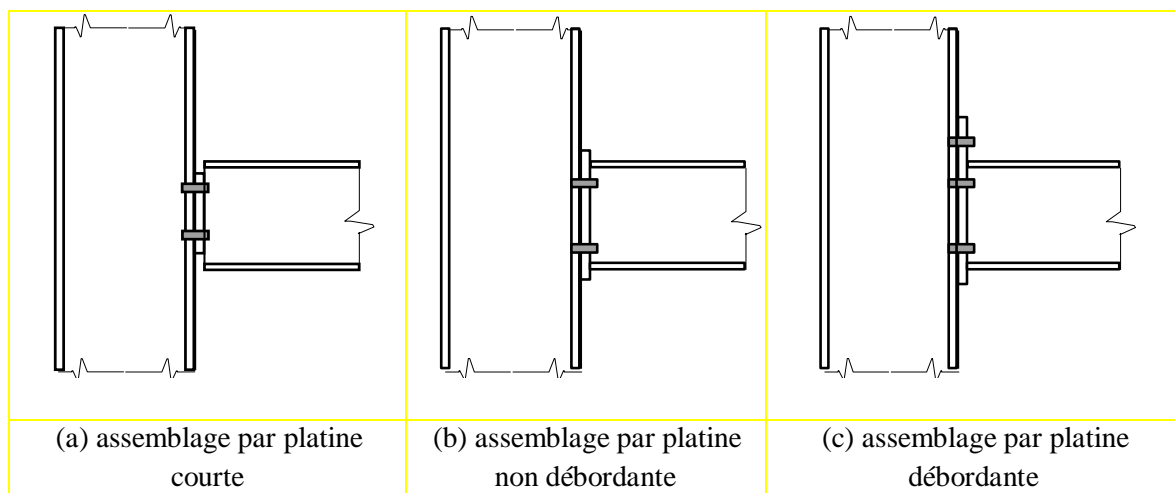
Assemblage poteau poutre par platine d'extrémité boulonnée
